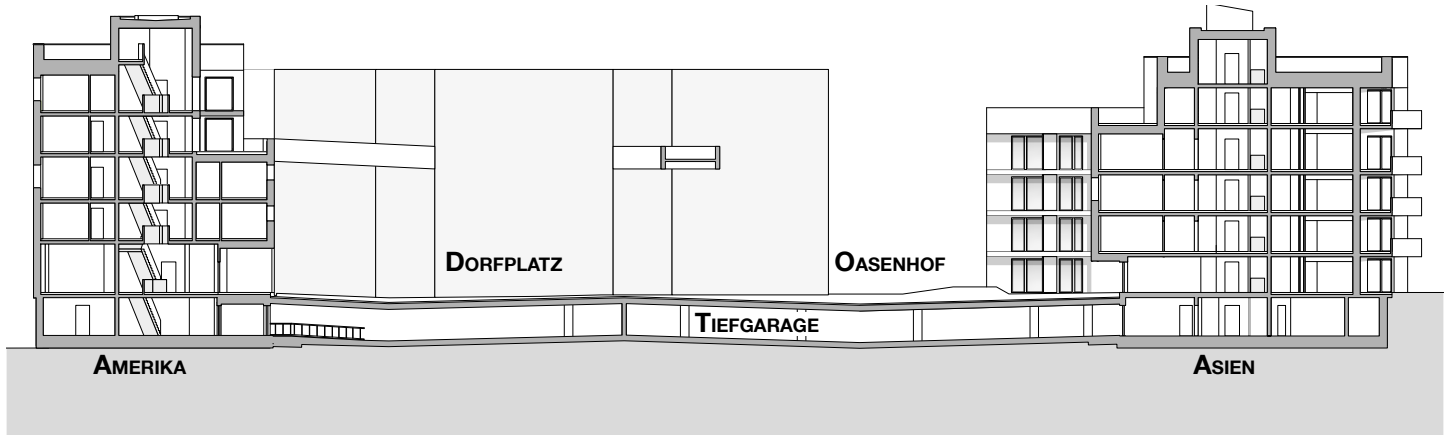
Längsschnitt mit Tiefgaragen-Unterkellerung (ohne Massstab)
